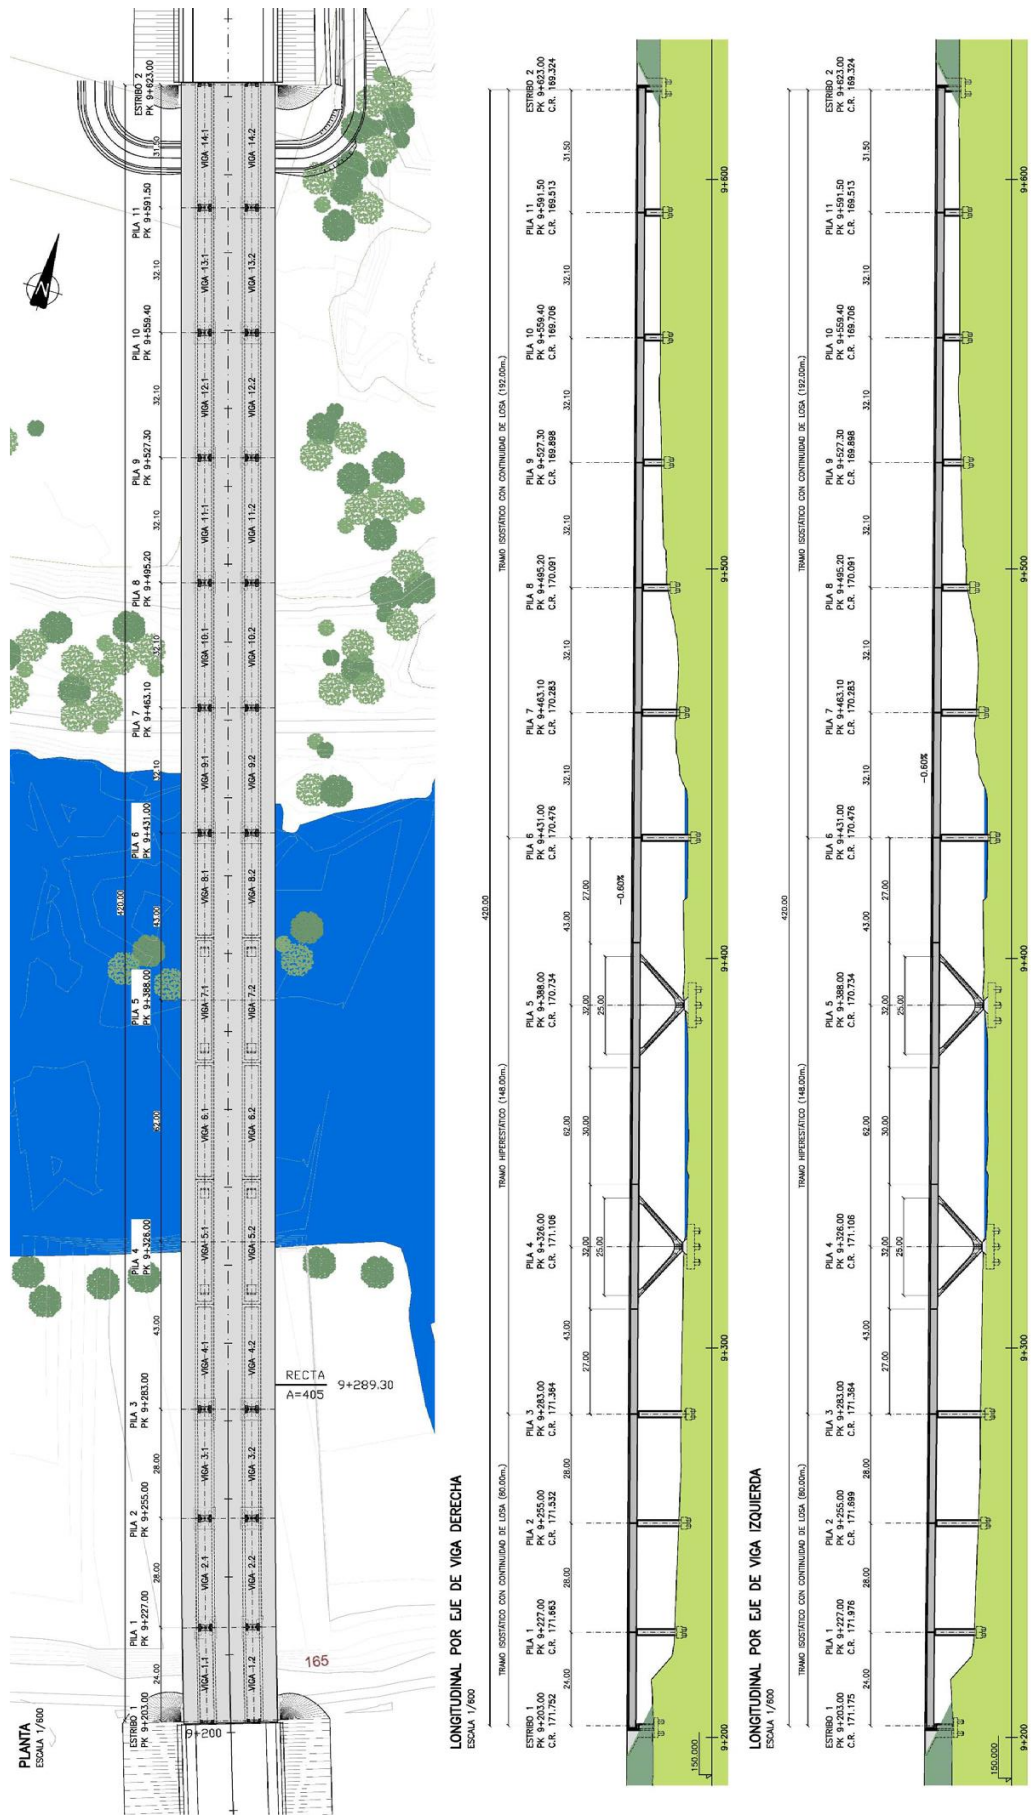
Perfil y vista en planta del viaducto. (Fuente: Planos anteproyecto)
